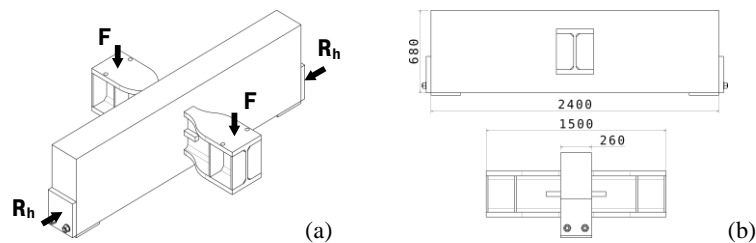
Vue isométrique des corps d'épreuve (a) et dimensions générales (b) (type CS-H+R).
